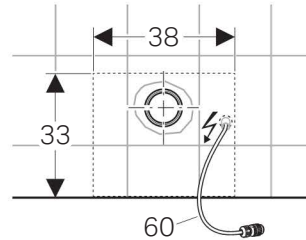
Bereich Elektroanschluss beim Geberit Monolith Plus Bauhöhe 101 cm und 114 cm
